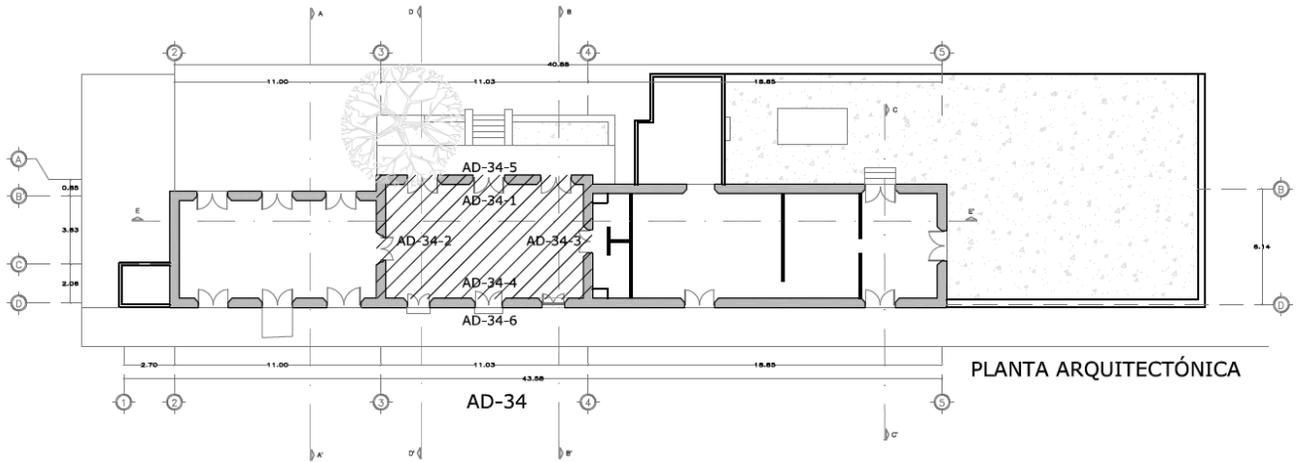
Ubicación de espacio AD34 en planta. PGPL, 2016.
